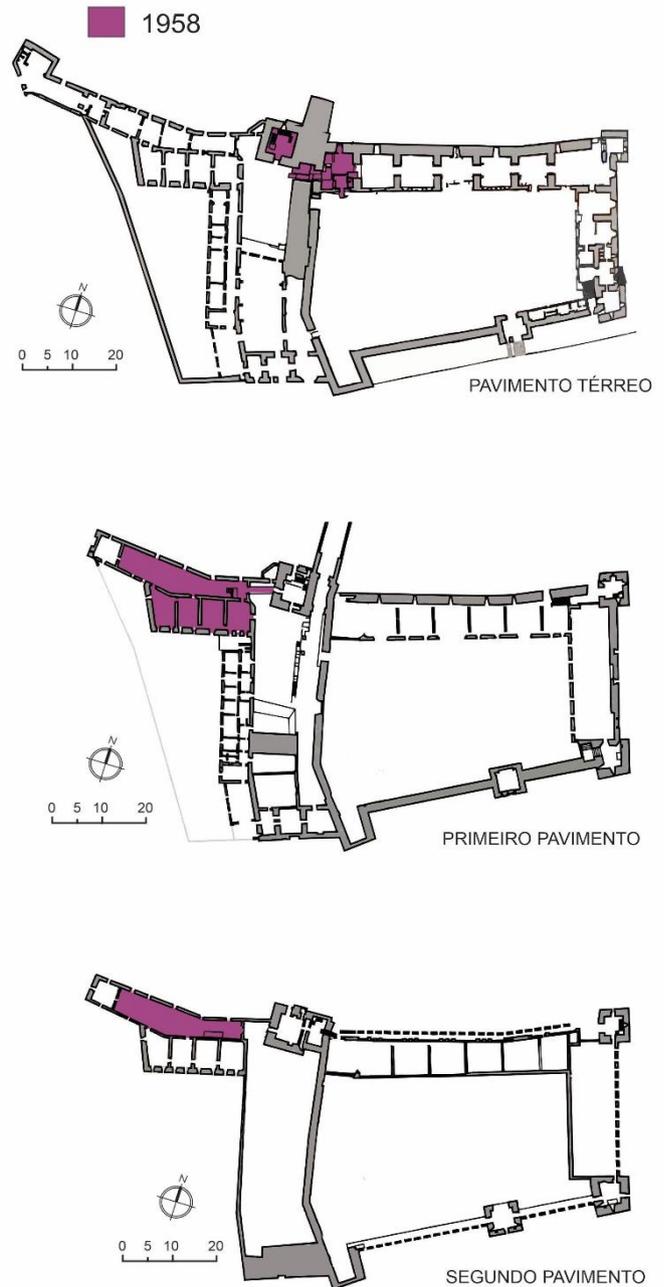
Pavimento térreo mostra a localização da Torre del Mastio | Primeiro e segundo pavimentos, que foram objetos de intervenção em 1958, apresentam a localização da *Ala Reggia
